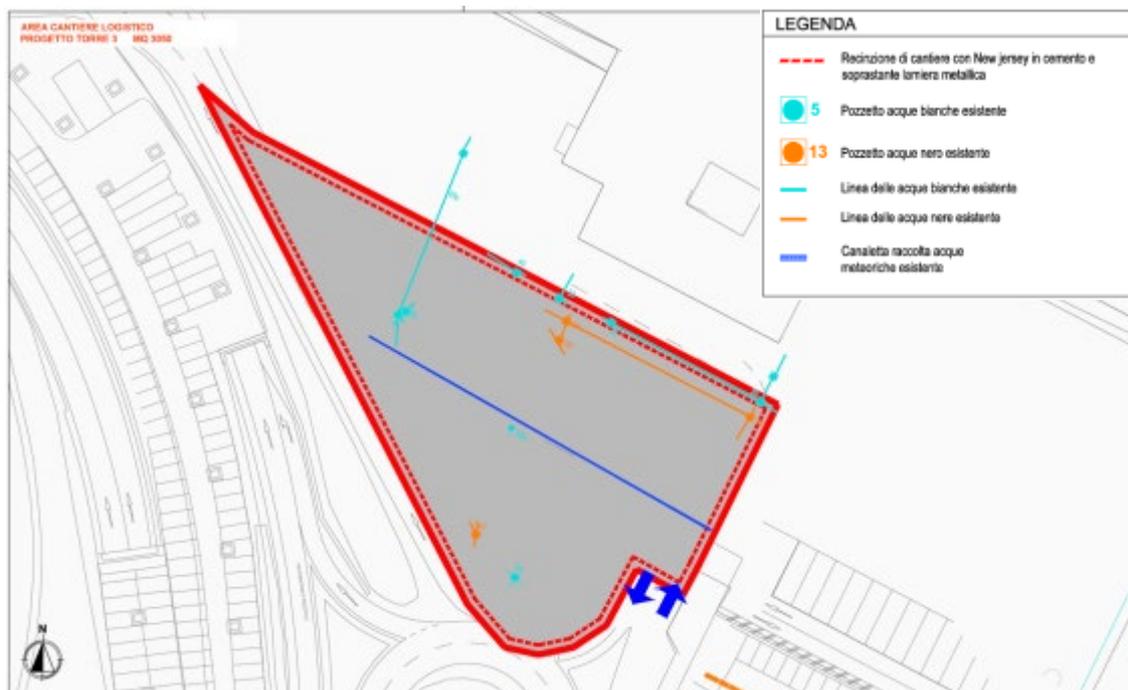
Planimetria dell'area di cantiere logistico: rilievo delle attuali reti acque bianche e nere
